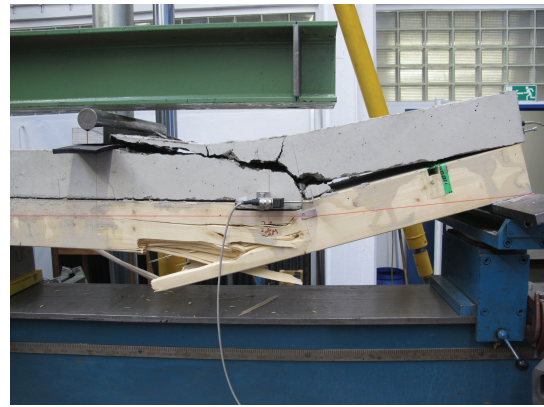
Rissbildung im Beton an Kerbe 2 des Trägers 10.3 (Laststufen 3 und 4)
